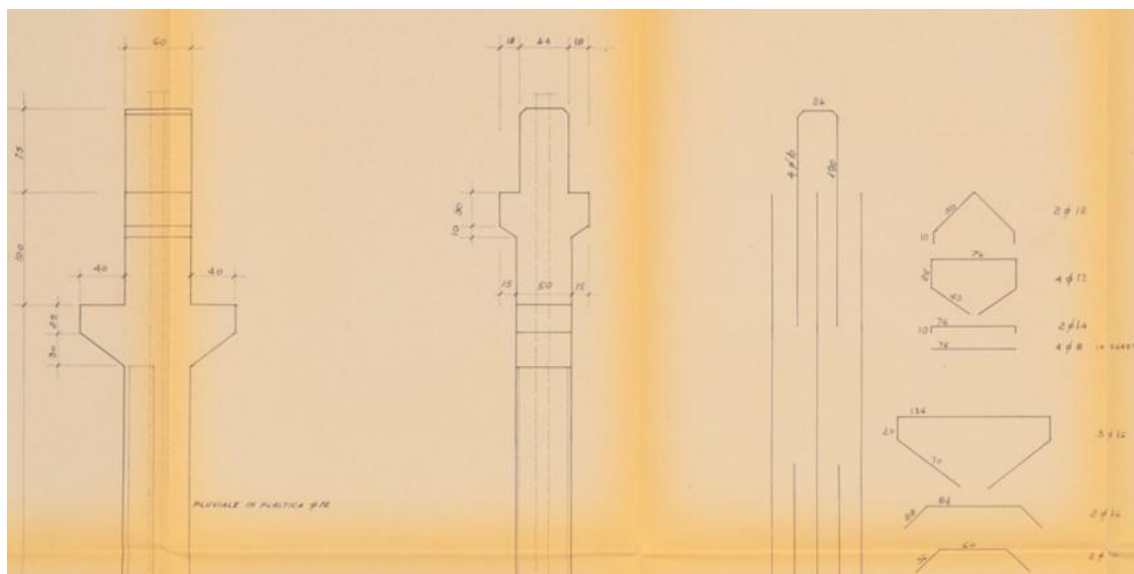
Particolare di A.1980.cap.us.T05 - Dettagli armature pilastri – Armature mensole
